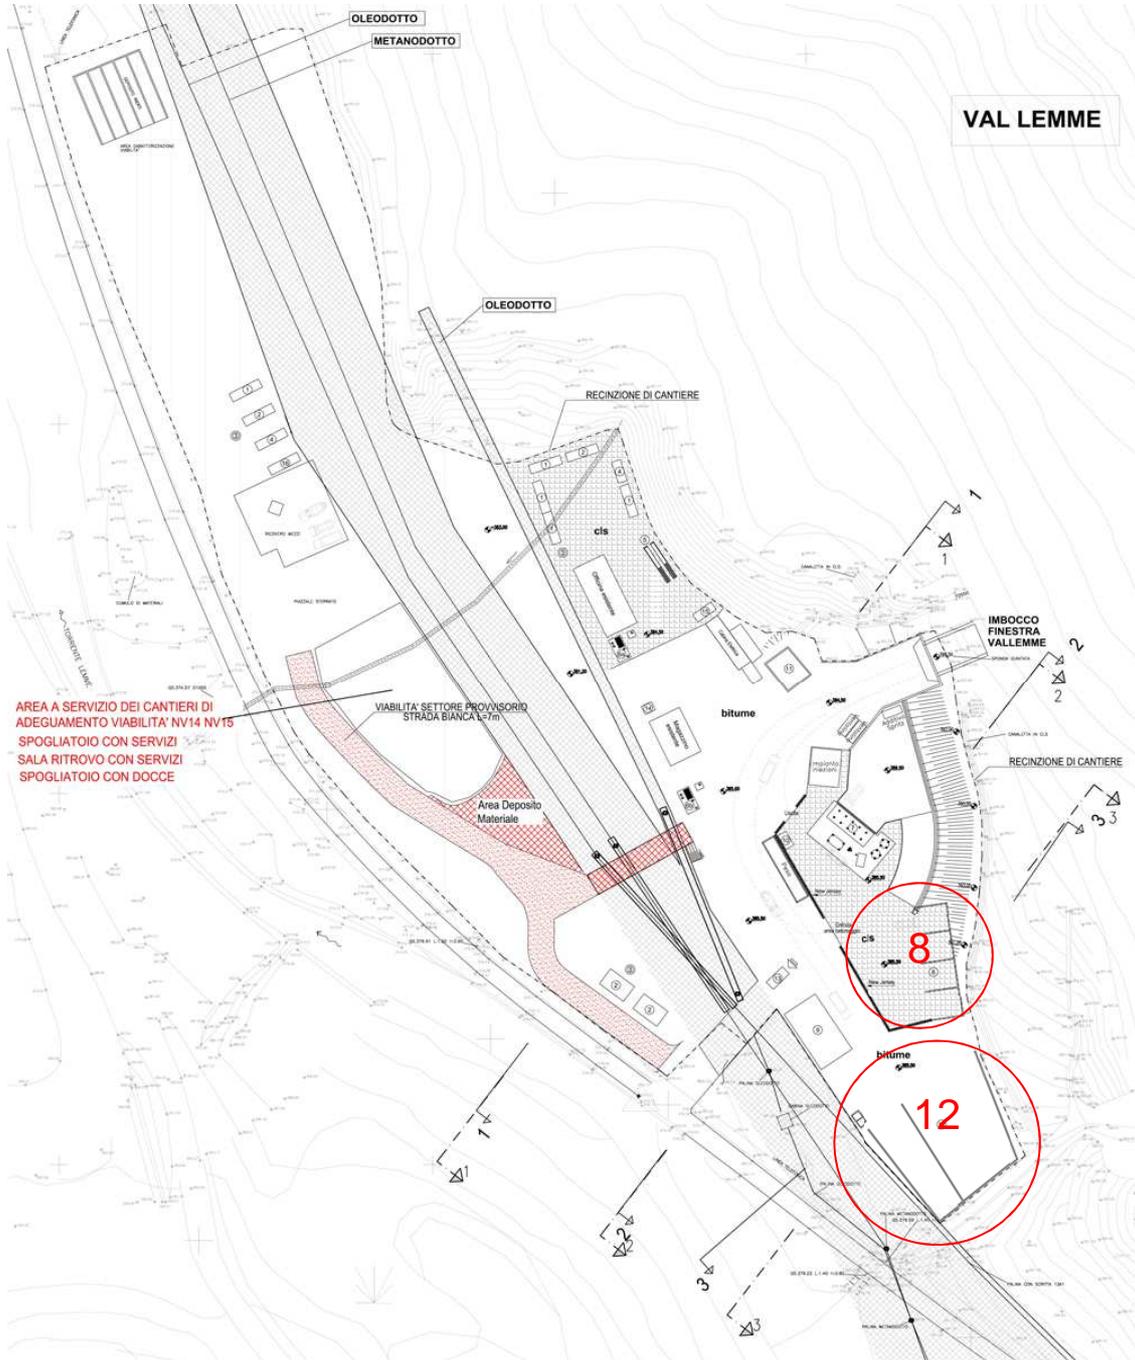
Stralcio della planimetria di progetto I Fase del cantiere CA17.
